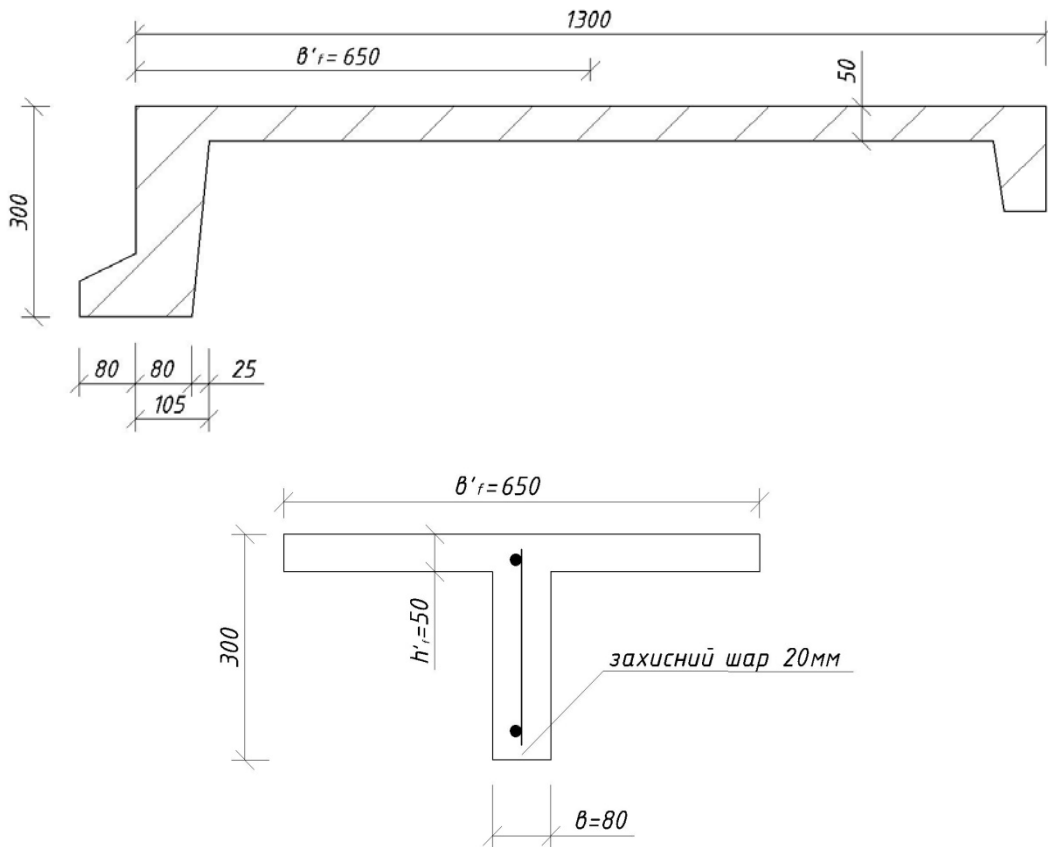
Розрахункова схема до визначення армування лобової балки та її умовний переріз ребра
